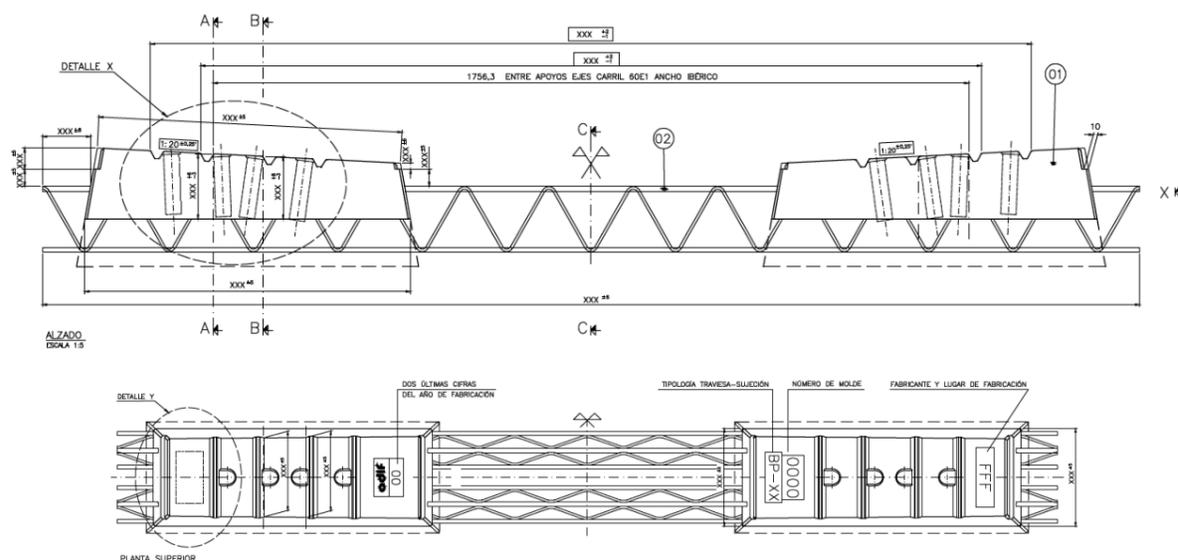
Alzado y planta de traviesa bloque polivalente
